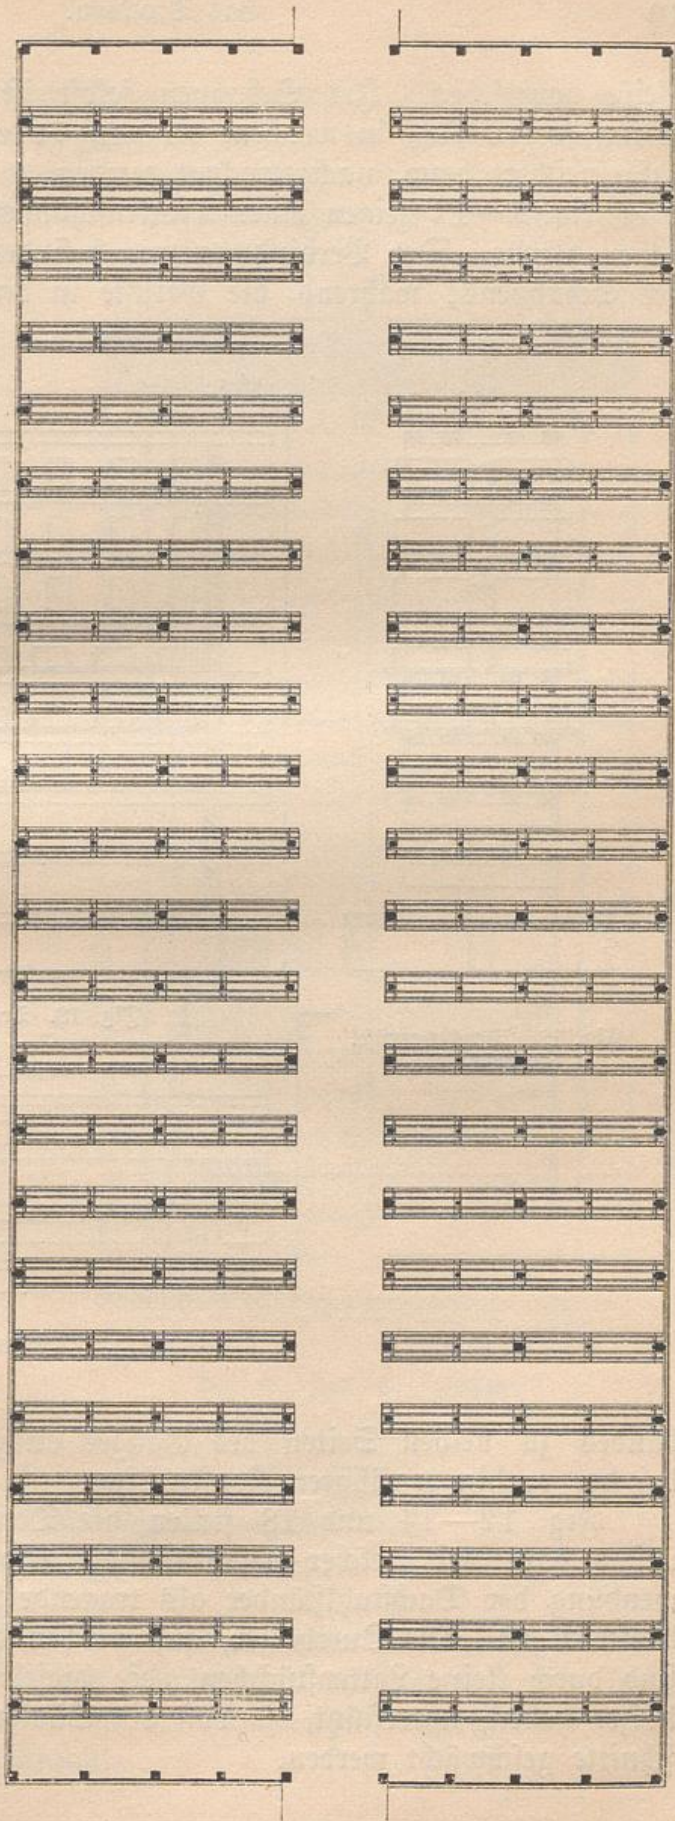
Trockenstuppen, 20 m breit. Grundriß.
